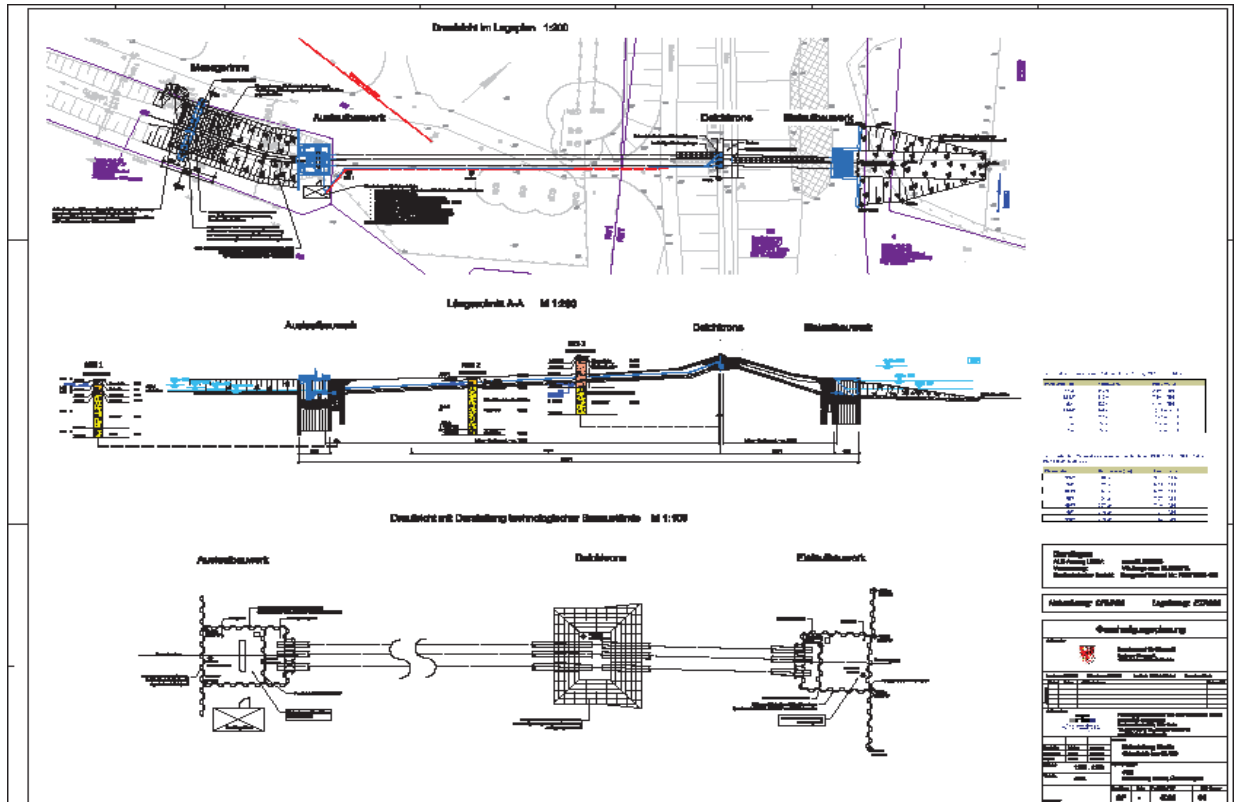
Lageplan & Längsschnitt / Draufsicht
